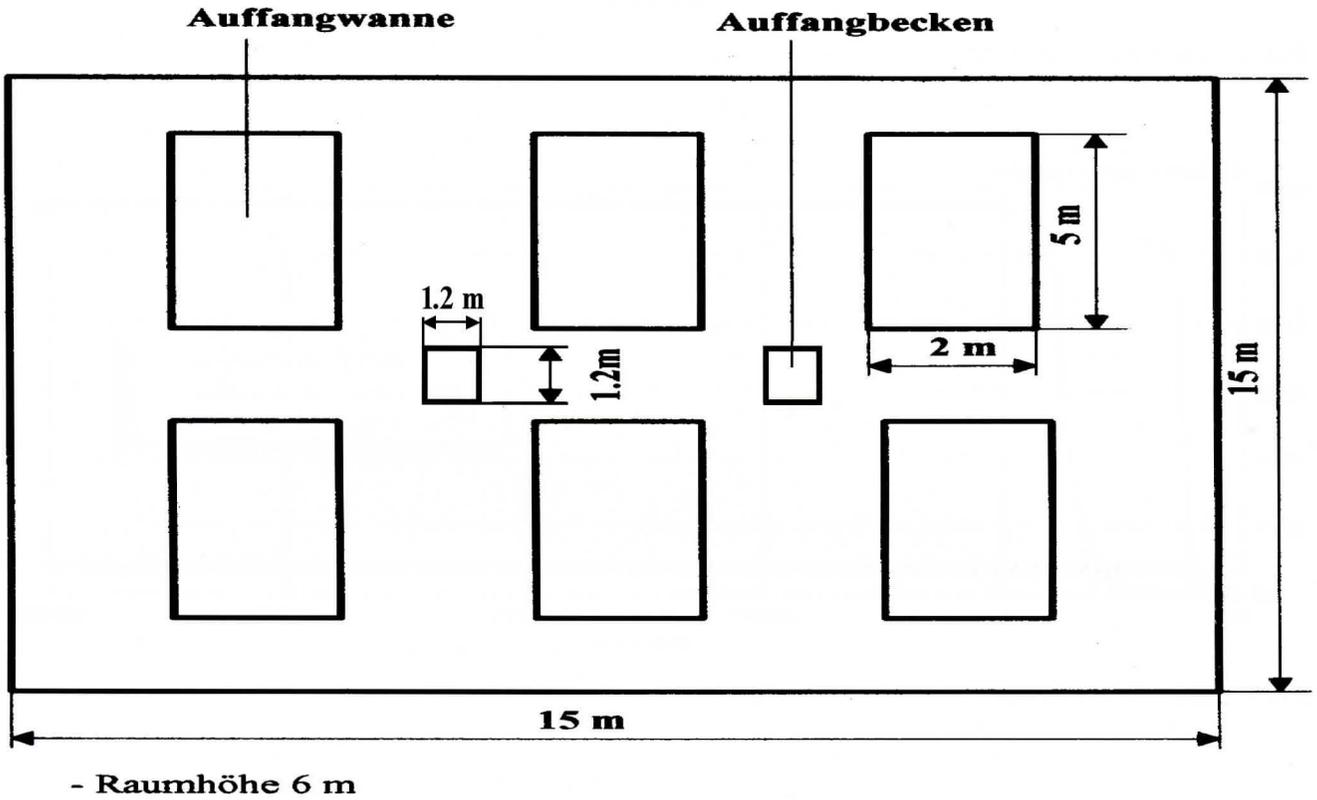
Grundriß und Einbauten des Brandraumes (Schematische Darstellung)
